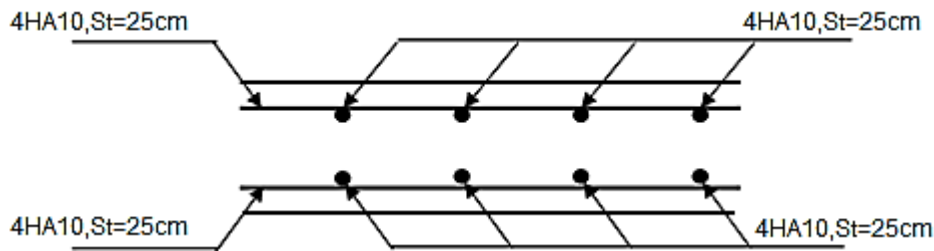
Vue en coupe du ferrailage de la dalle de l'ascenseur
